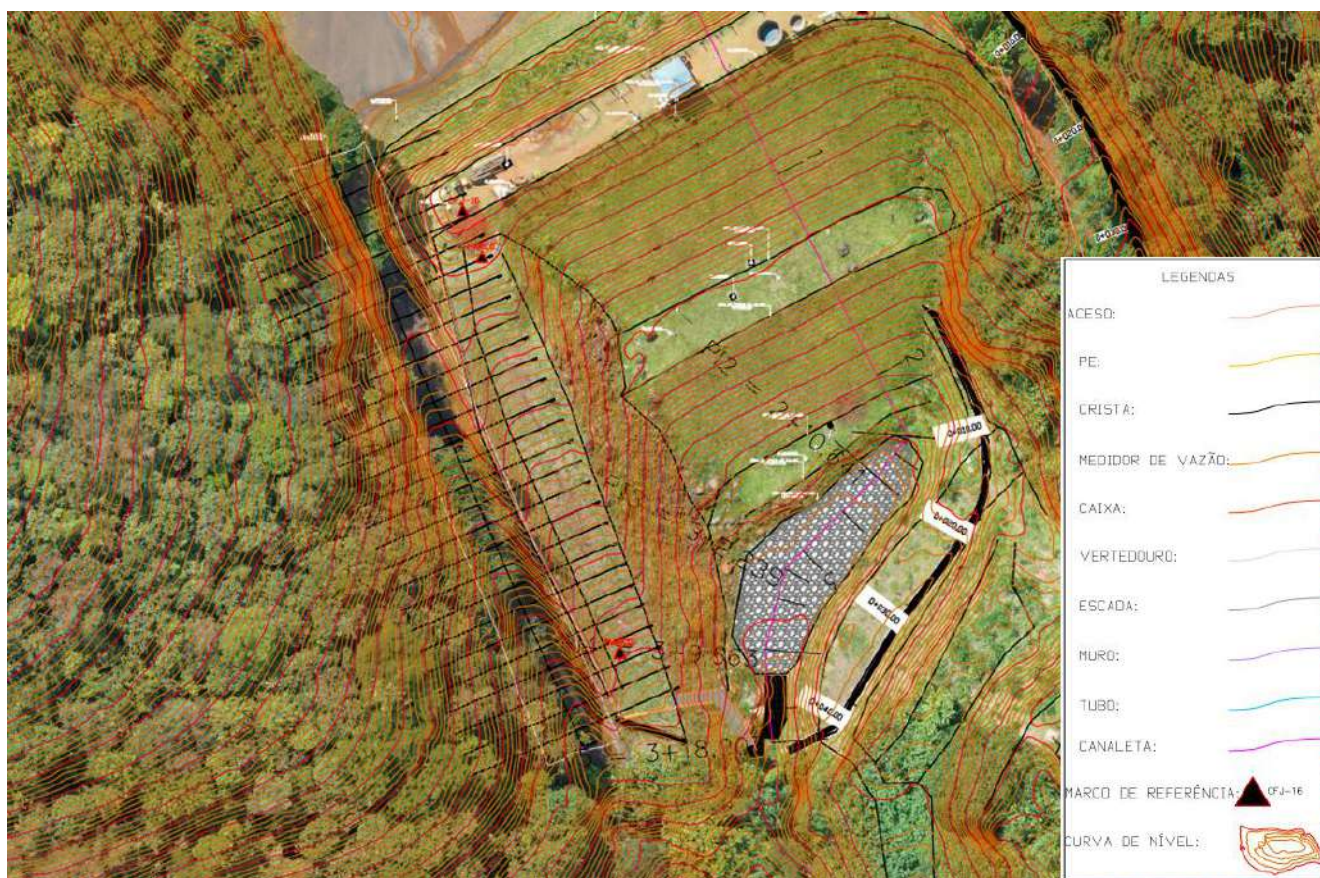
Planta e Ortofoto do Vertedouro da Barragem Menezes I (Fonte: Rural Tech, 2022).
